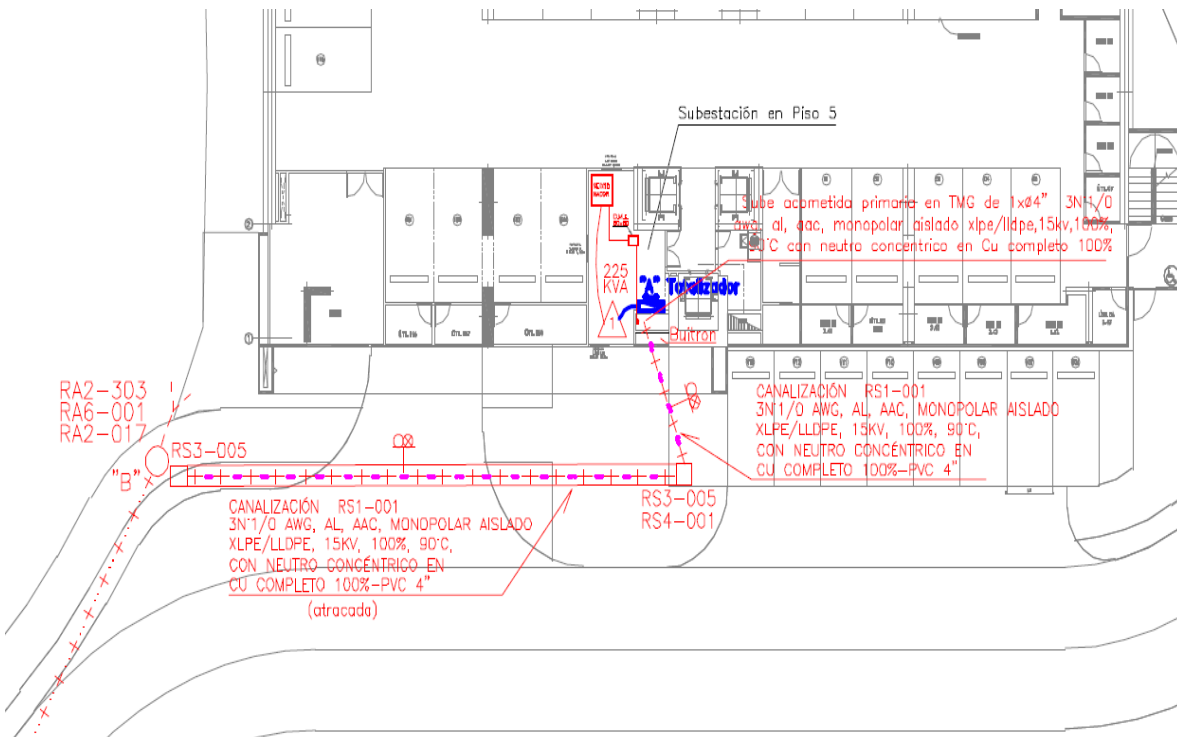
Proyecto de redes, canalización exterior hasta subestación eléctrica.
